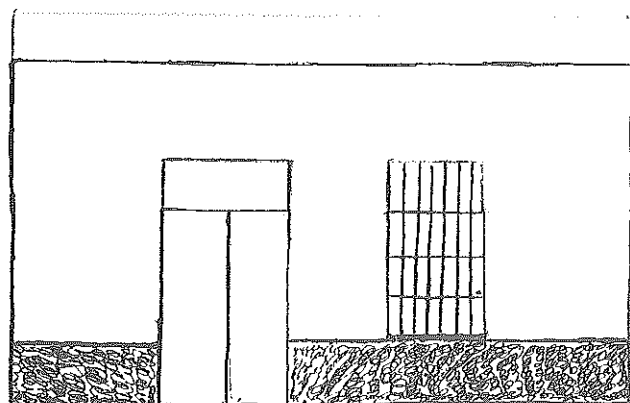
Proyecto de modificación de fachada en la Calle la Gloria, nº 18 (A.M.O. F-17, nº 51)
